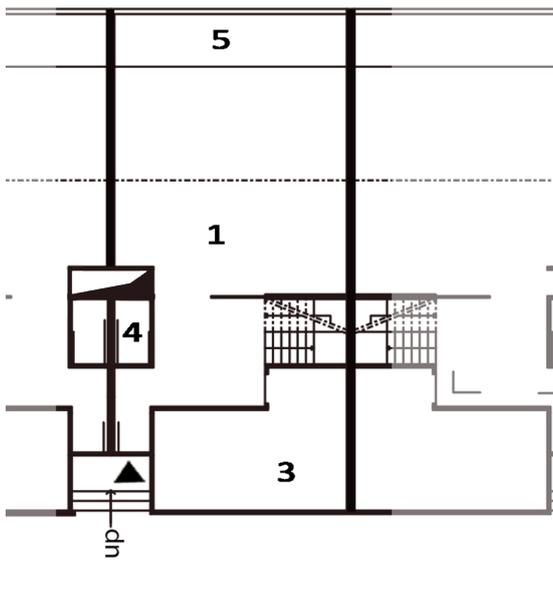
Das Hochhaus- Wohnung- Grundriss & Bild M:1/200
